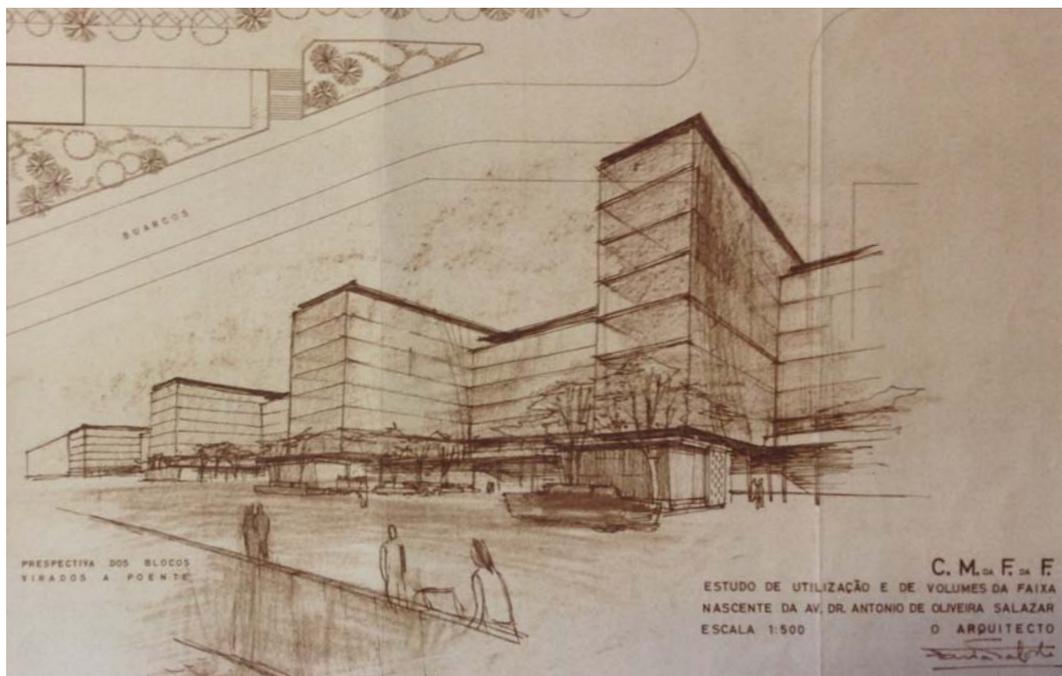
Perspectiva das Construções Idealizadas para a Avenida Marginal, João Guilherme Faria da Costa, 1961
